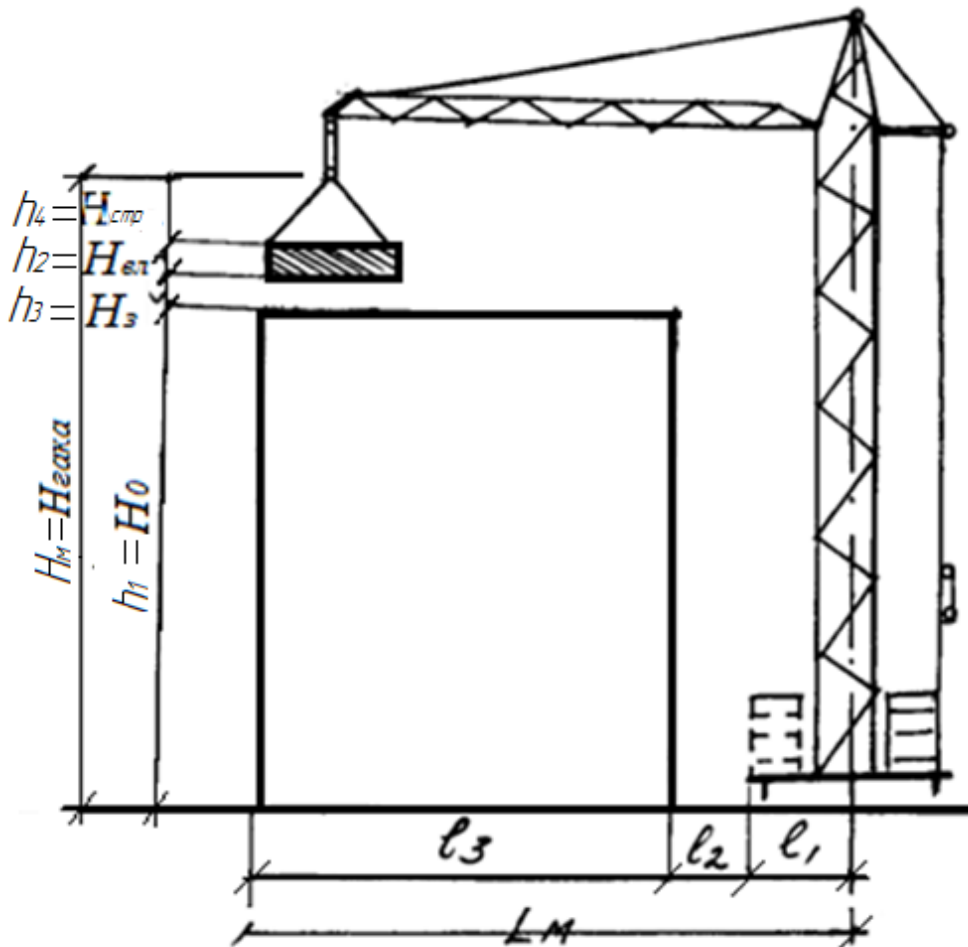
Схема для визначення монтажного вильоту стріли баштового крана
